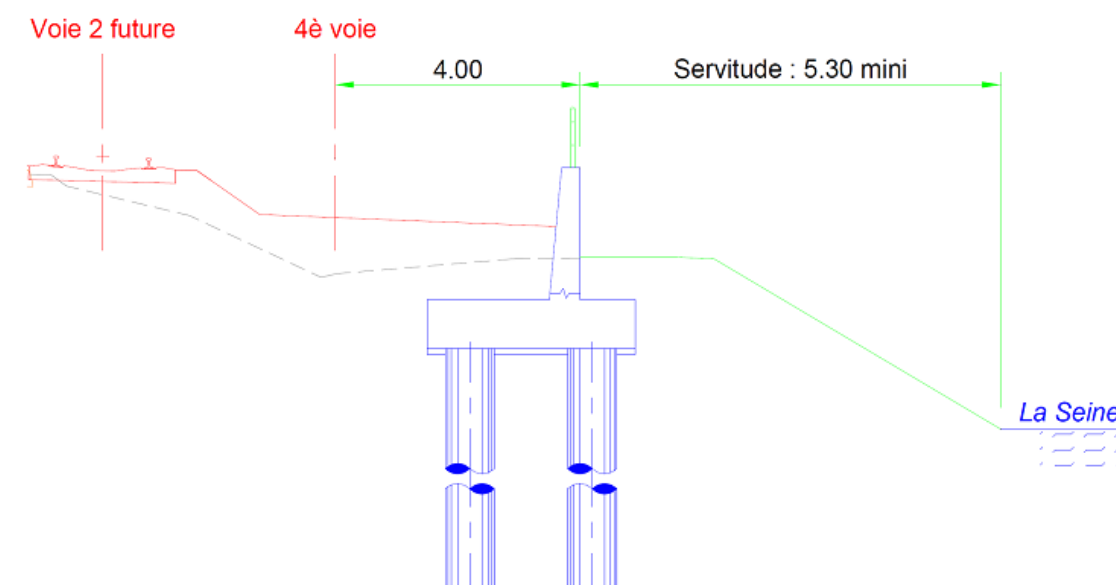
Coupe schématique de la voie projetée, cas avec mur de soutènement
